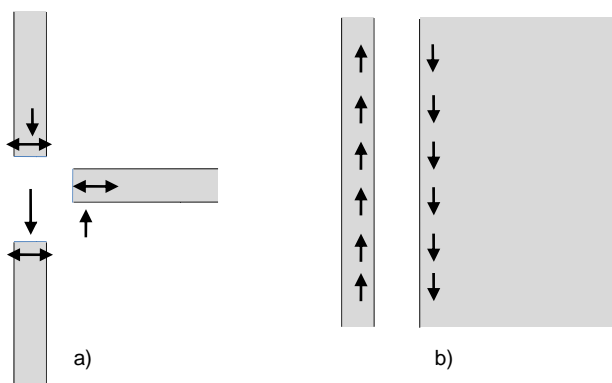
Trasmissione delle forze fra pareti e solai: a) sezione verticale - b) sezione orizzontale
